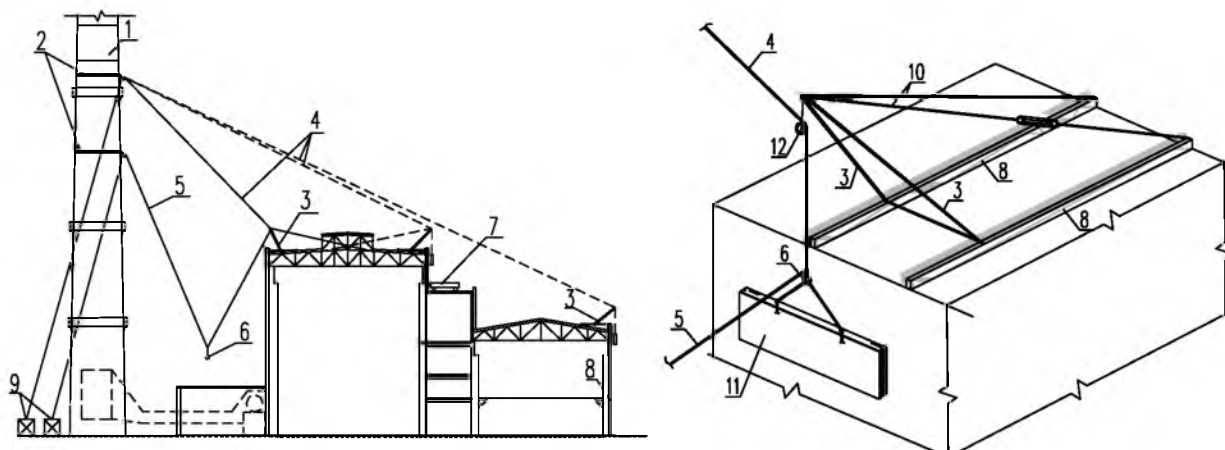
Технологическая схема «Лакра-2»: 1 – основная опора; 2 – обводной канат; 3 – монтажная стрела; 4 – основной канат схемы; 5 – оттяжной канат; 6 – грузовое устройство; 7 – транспортная тележка; 8 – опорные балки; 9 – электролебедки; 10 – оттяжка стрелы; 11 – стеновая панель; 12 – монтажный блок
